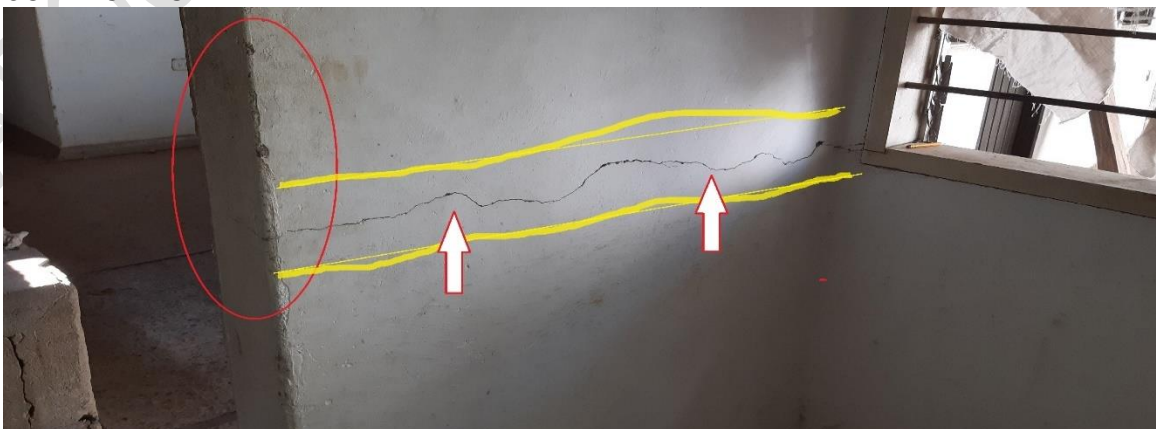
Fractura horizontal en muro, con desprendimientos de enlucidos y desplazamiento del plano frontal.
